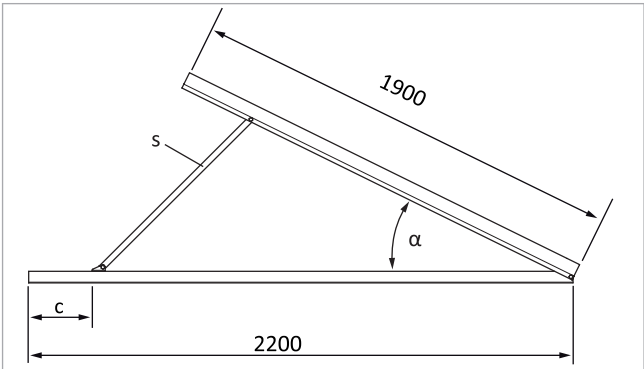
Soporte para tejado plano, dimensiones y ángulo de colocación
